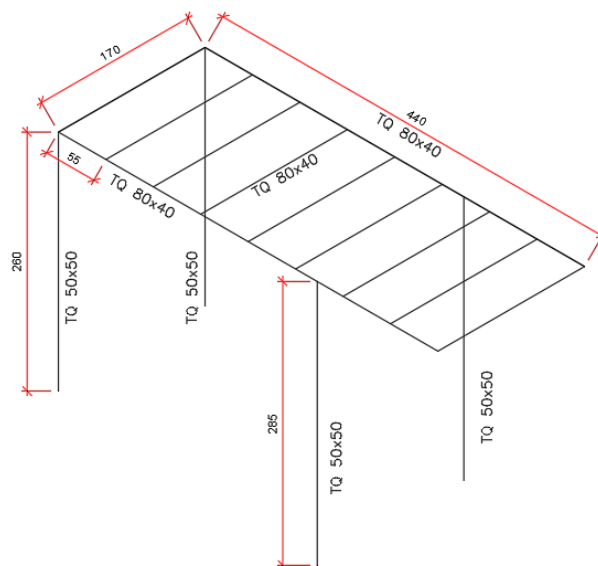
Detalhamento das medidas e perfis da estrutura de cobertura.
